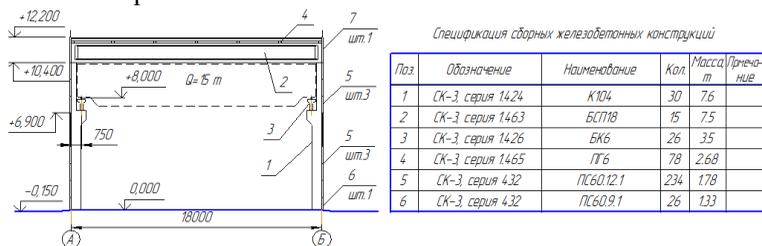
Сборные конструкции одноэтажного каркасного здания производственного назначения: 1 – колонна сплошная для зданий с мостовыми кранами (К104), 2 – балка стропильная с параллельными поясами (БСП18), 3 – подкрановая балка (БК6), ребристые плиты покрытия (ПГ6), 5, 6 – панели стеновые (ПС60.12.1, ПС60.9.1)
